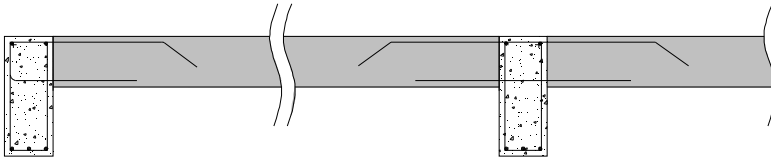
Utilização de lajes alveolares sem apoio direto em estruturas totalmente moldadas no local (adaptado de ASSAP, 2002)
